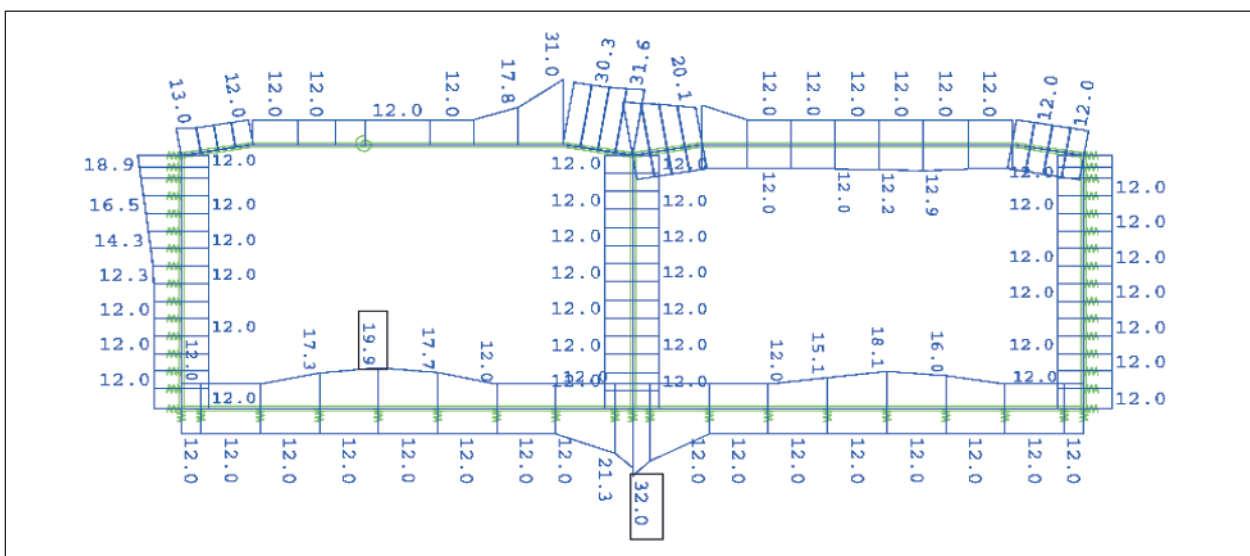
Biegebewehrung aus außergewöhnlicher Bemessungssituation nach dem Brand [cm²/m]
